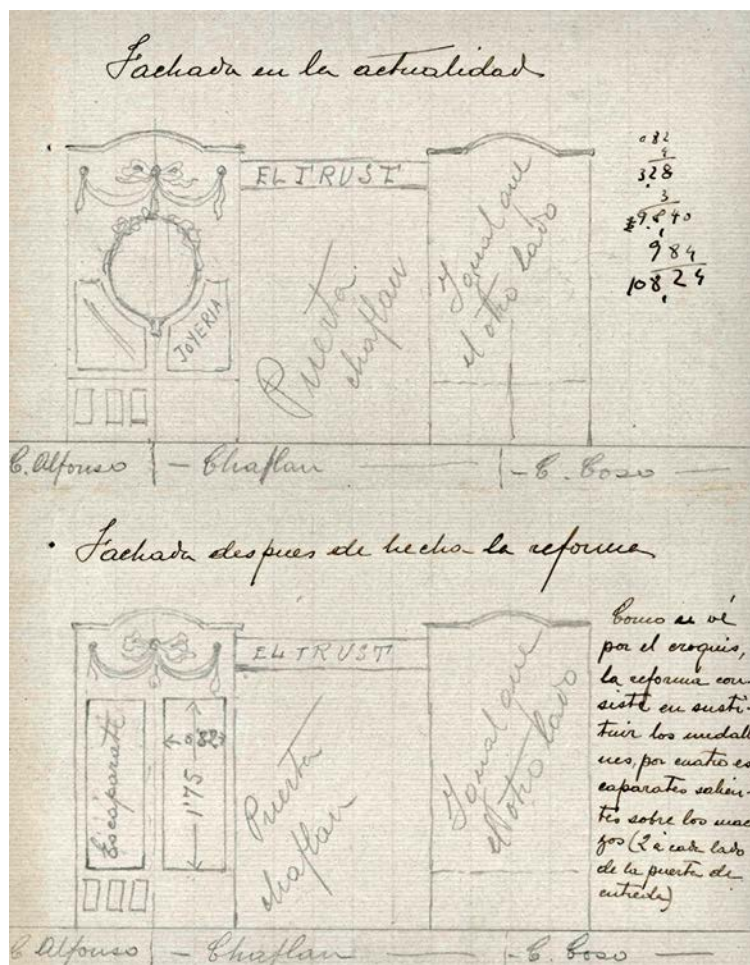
Croquis de la fachada existente y de la reforma planteada en El Trust de Zaragoza. 1913. AMZ
